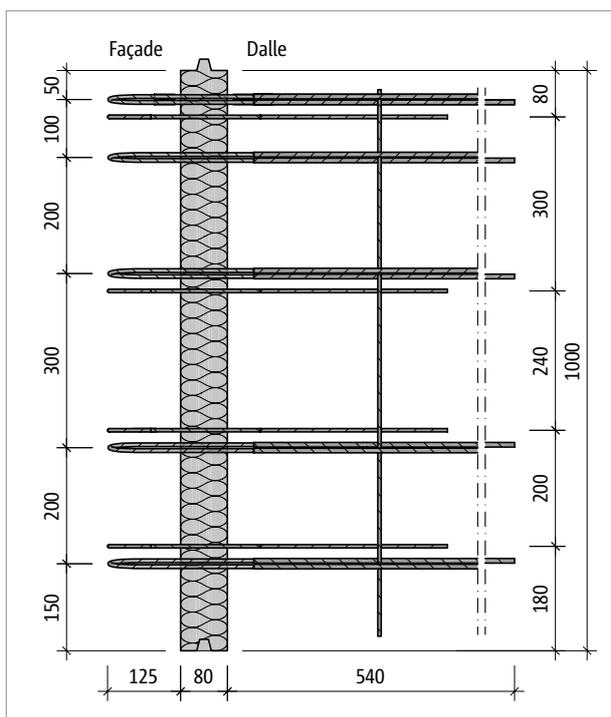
Schöck Rutherma® T type DF-V3-LR125 : vue en plan du produit
